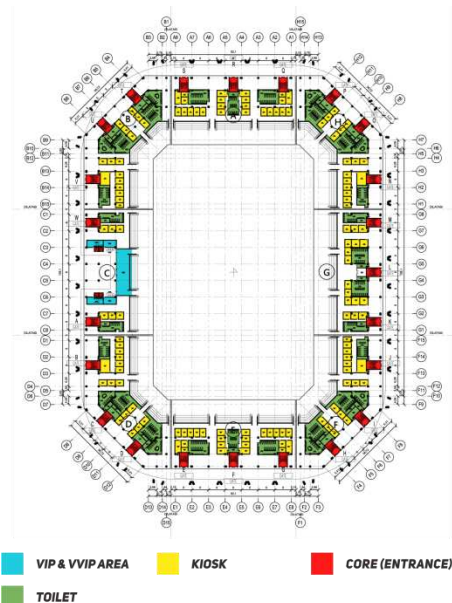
Denah Lantai 1 PSPS Home Stadium
